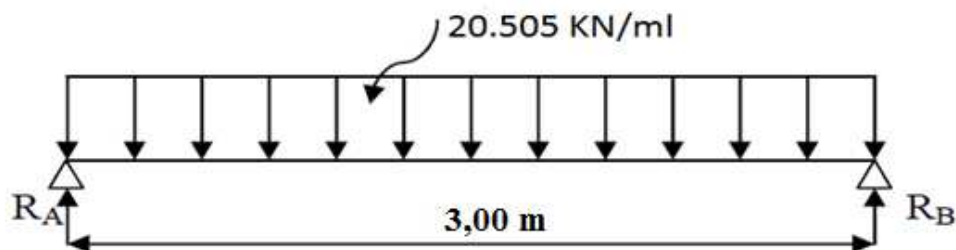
Schéma statique de la poutre palière l' ELS.
